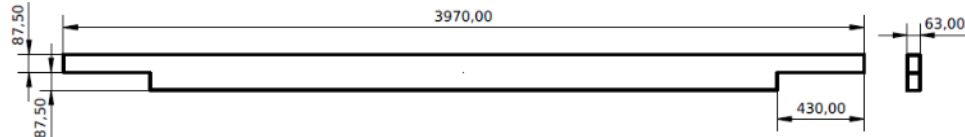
Dimensions en mm d'une poutre à entaillée
